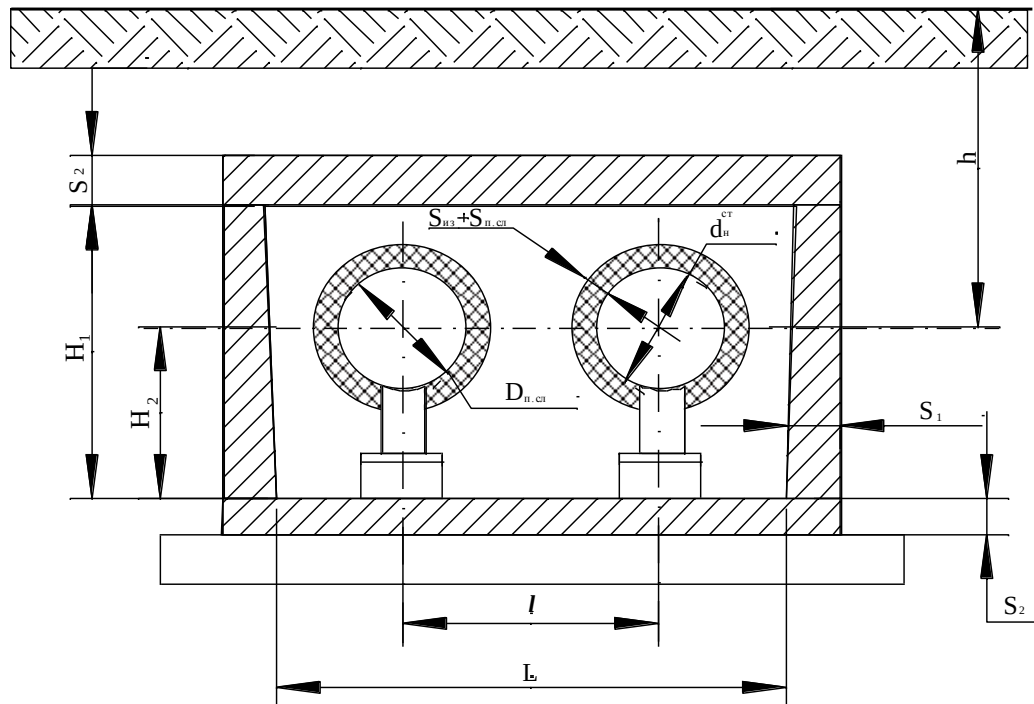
Расчетная схема подземной канальной прокладки теплотрассы
